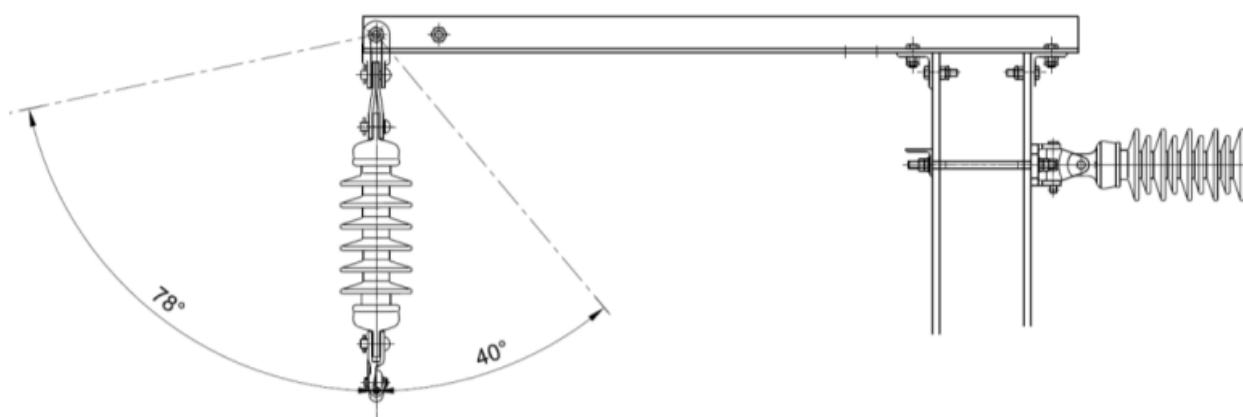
Montagem do feeder – Pormenor da montagem para o lado do campo
